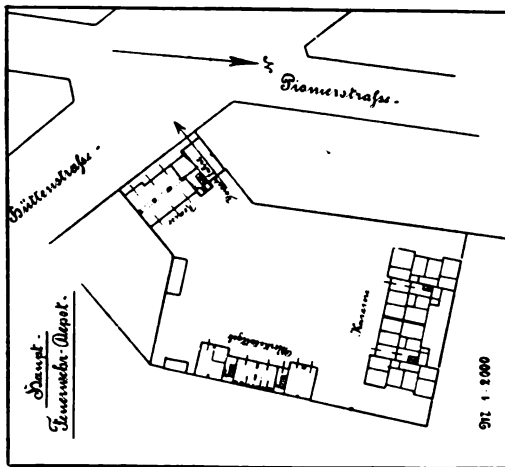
Lageplan des Feuerwehrdepots an der Hüttenstrasse.
